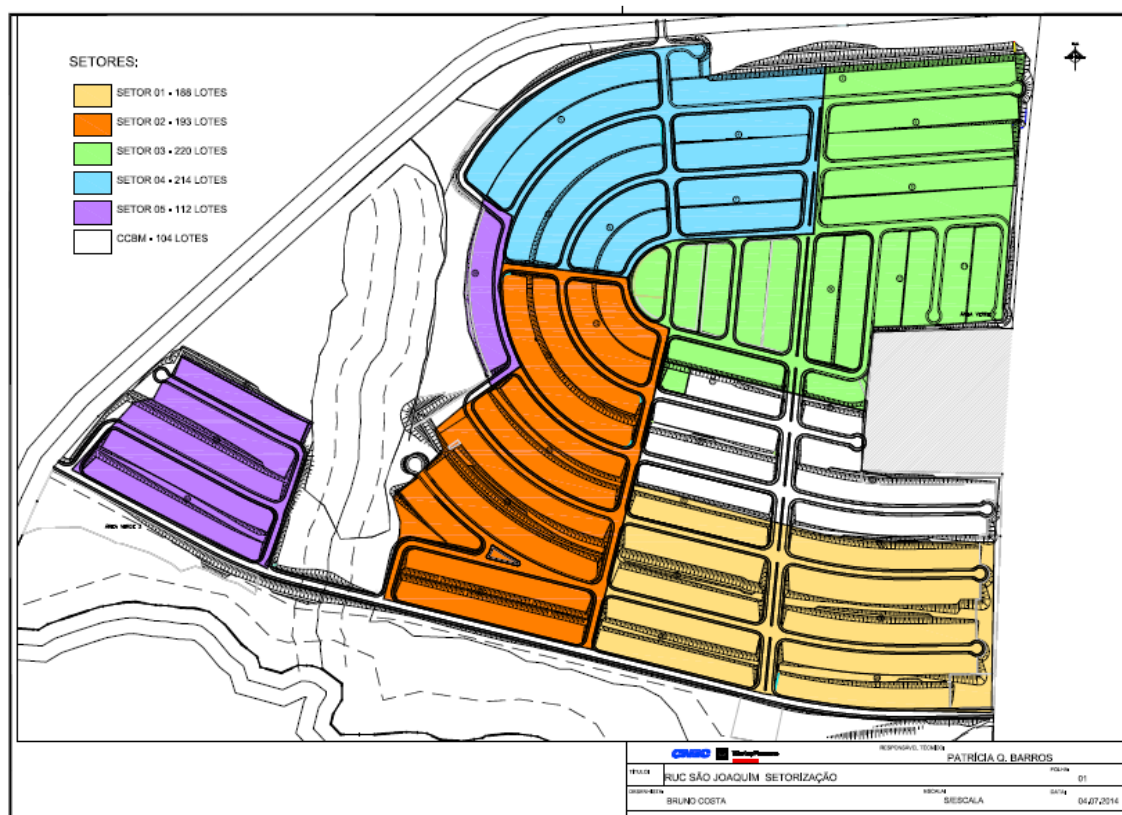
Setorização do bairro São Joaquim.
